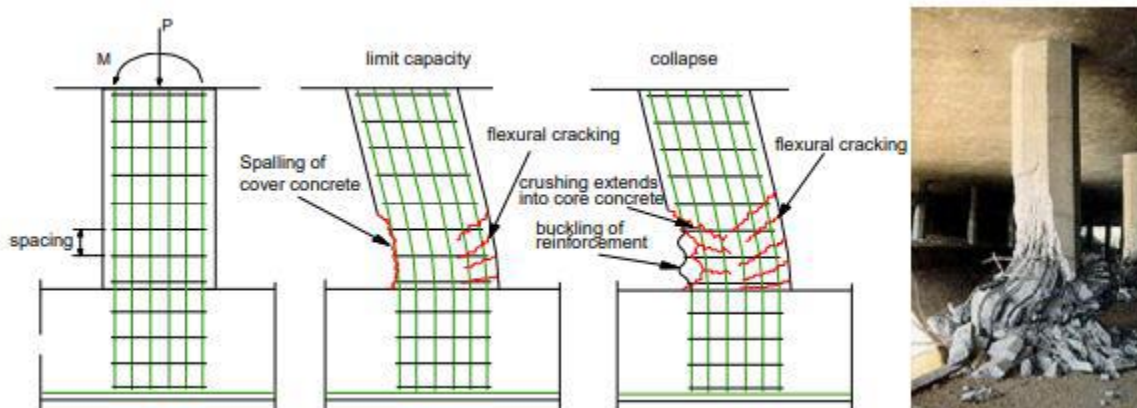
Rupture par plastification de la zone critique du poteau court (gauche) ; Mécanisme de ruine ; (droite) rupture d'une pile de pont lors du séisme [23].
